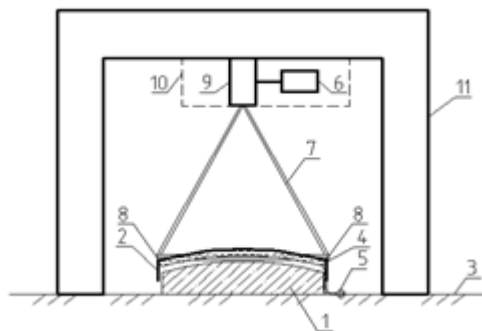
Электромеханический стенд для испытания железобетонных оболочек и плит
